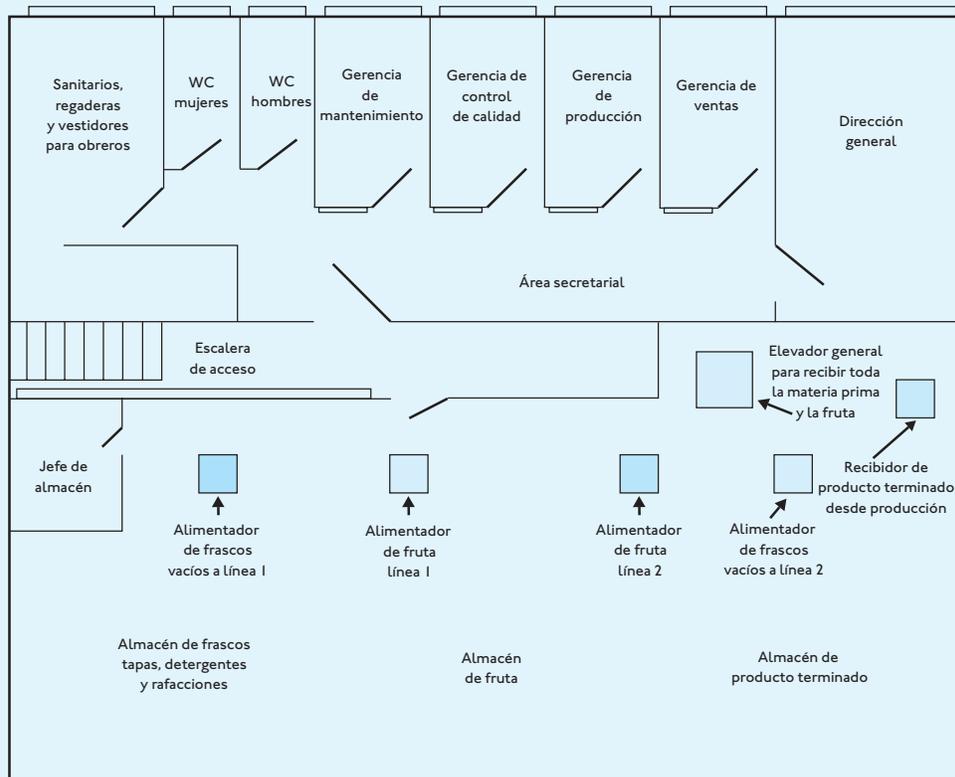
Alternativa 4. Nuevas áreas y nueva distribución de la planta alta.
